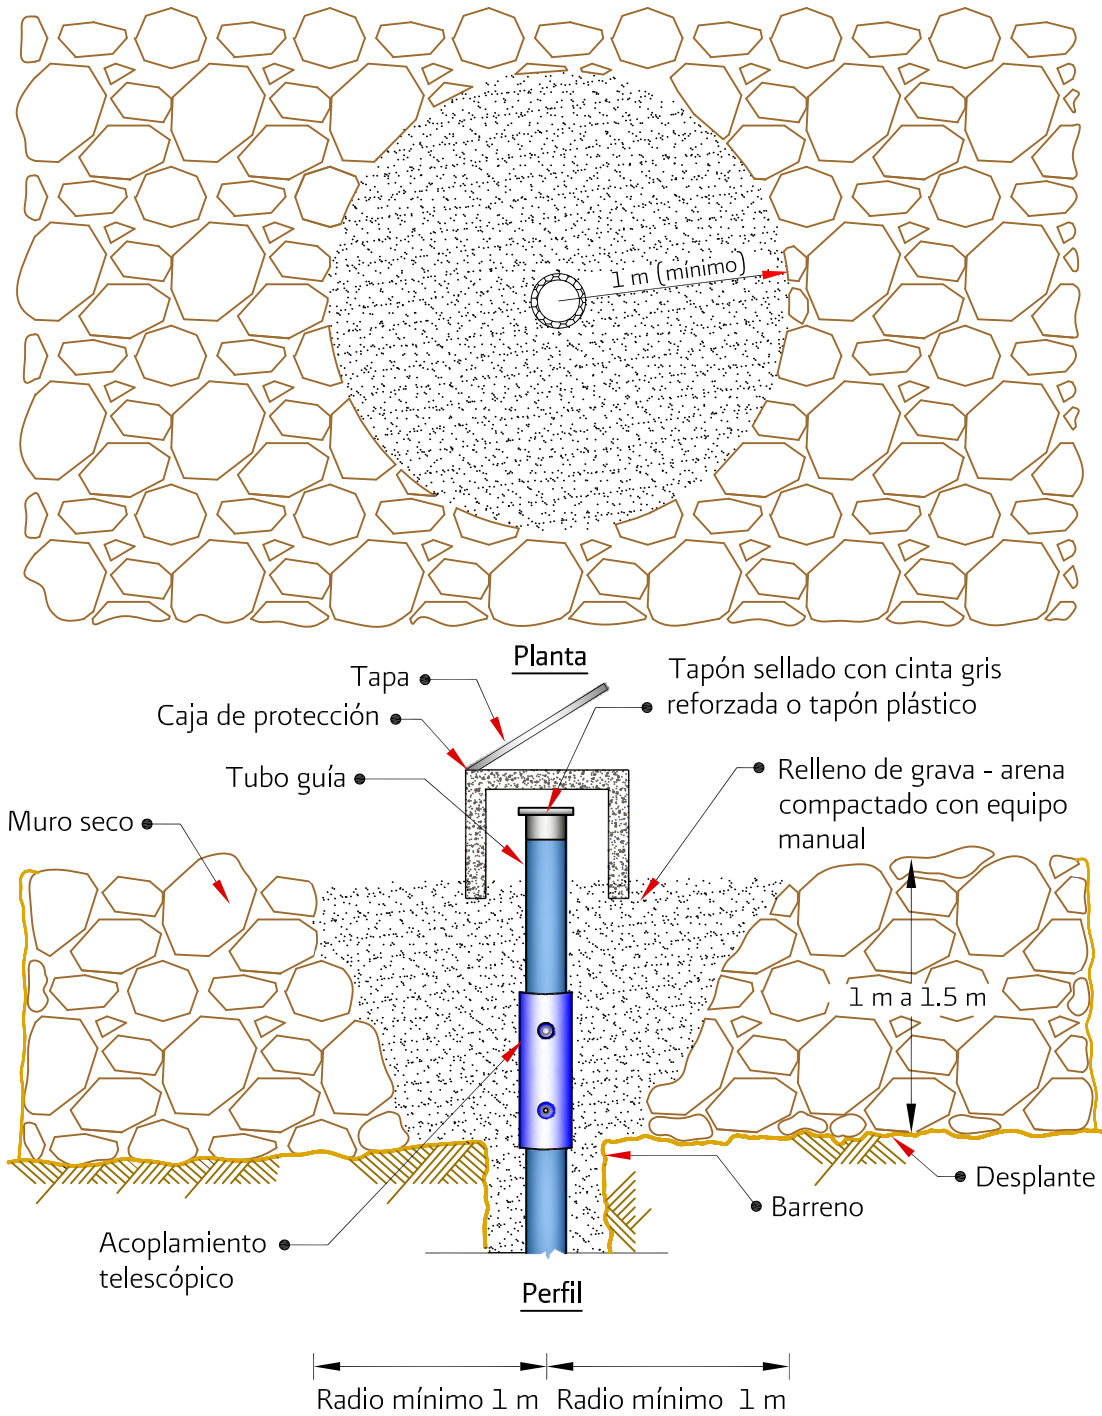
Protección en sobreelevación del tubo guía en los respaldos (rezaga o enrocamiento)
